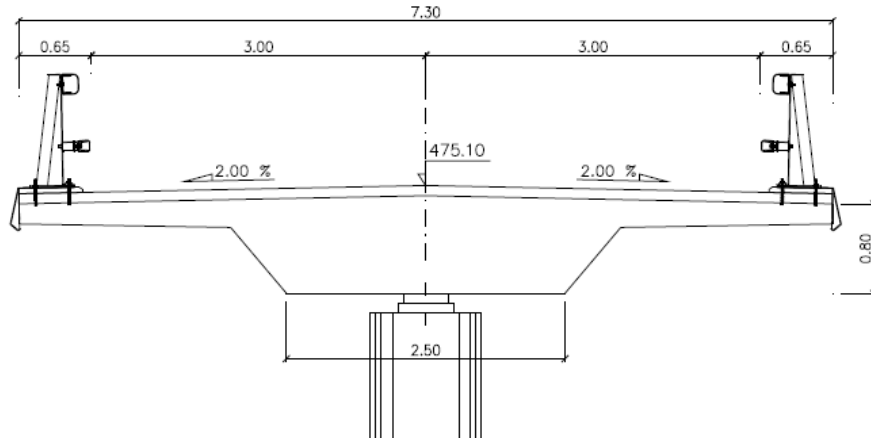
Detalle Estructura 4 y 5 Alternativa 2
